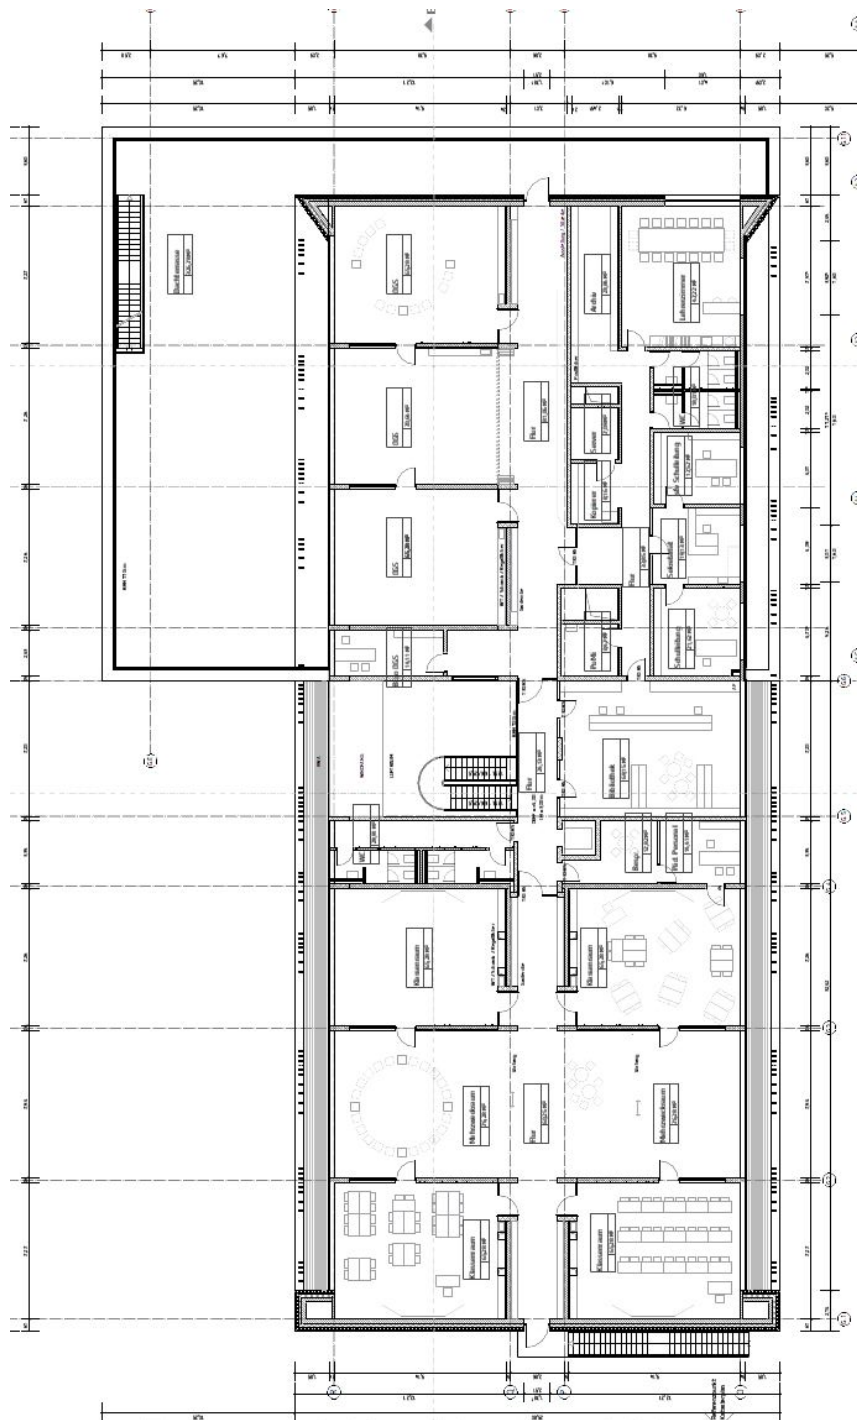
Grundriss Obergeschoss Neubau einer 2-zügigen Grundschule mit Mensa
